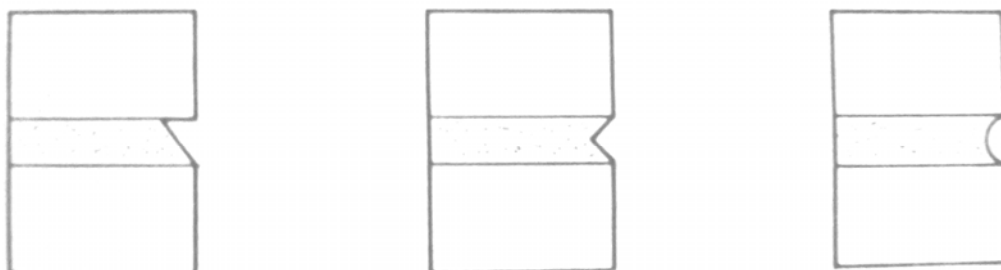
Frisamento de juntas em alvenarias aparentes de fachadas
